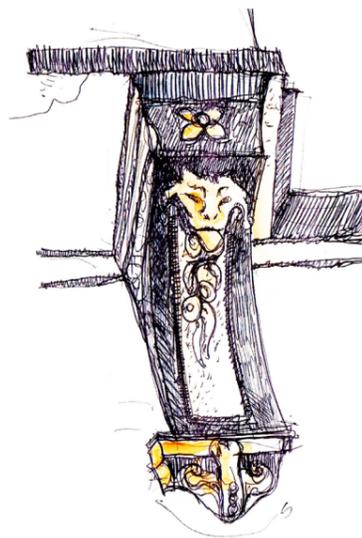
Detalle de mensula de baranda con mascarón. Fuente: Fot. autores (2014).
